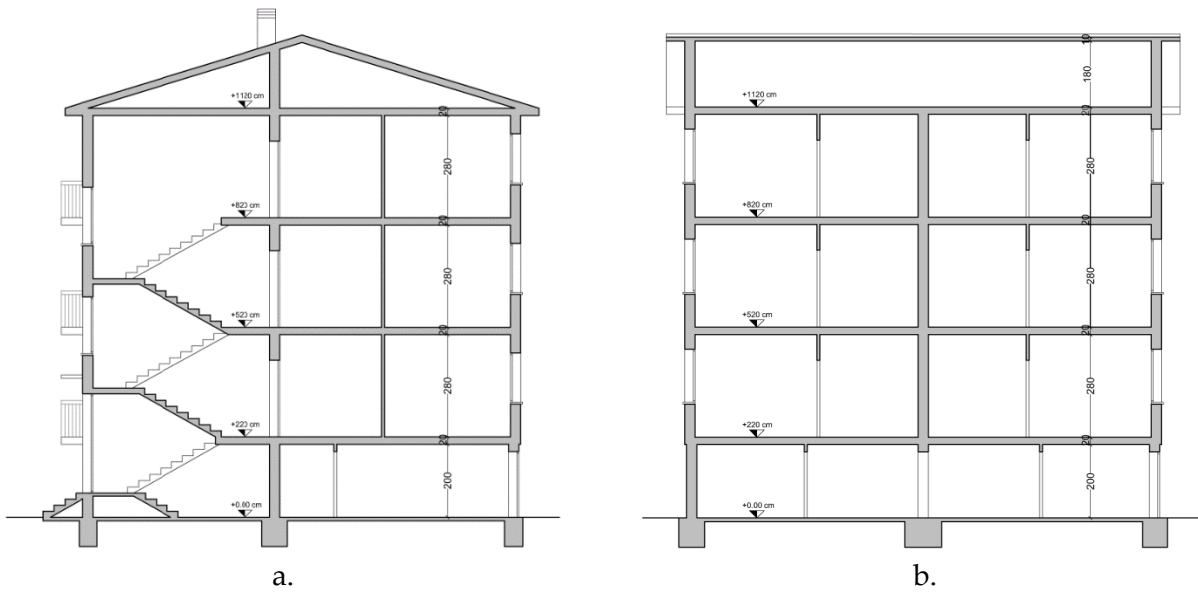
Sezioni: a) sezione A-A; b) sezione B-B.
